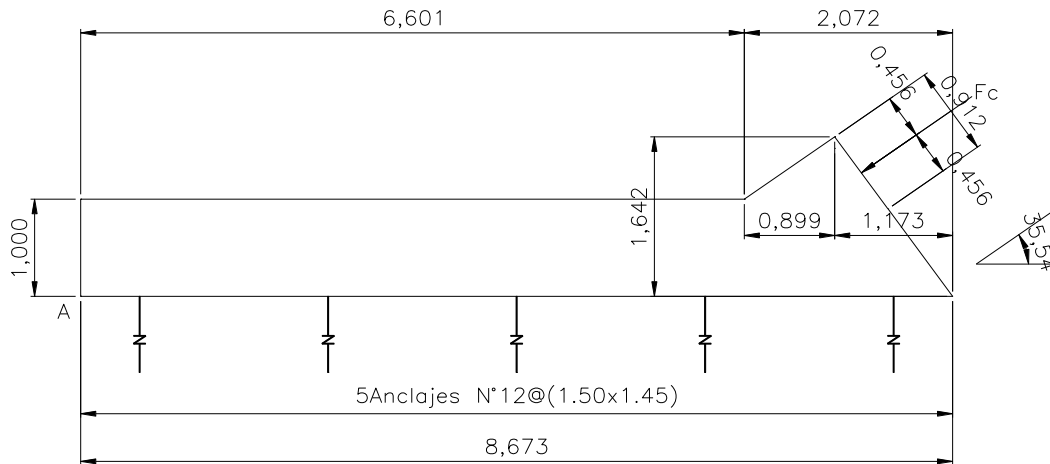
Cargas actuantes sobre el plinto.
